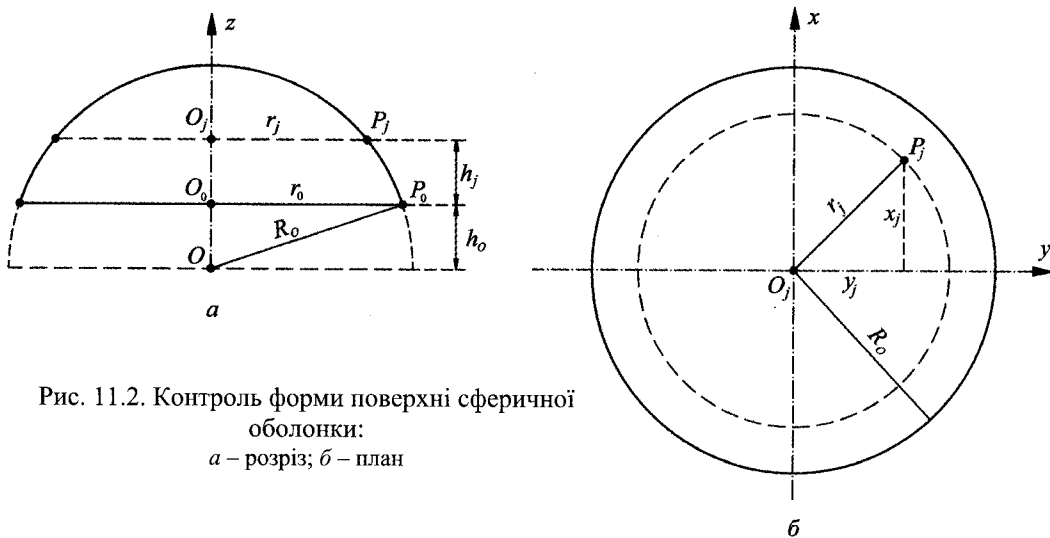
Контроль форми поверхні сферичної оболонки:
